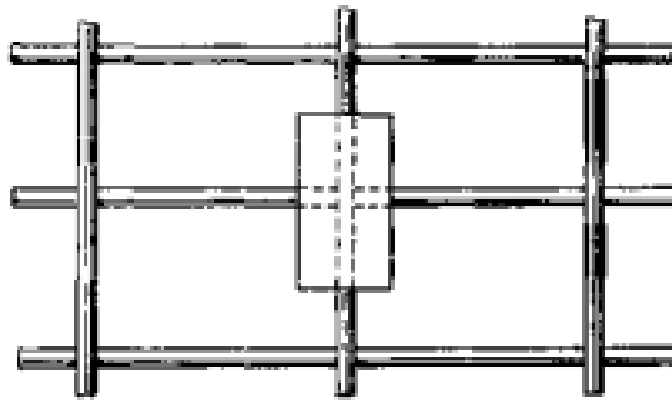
Схема розташування перетворювача при контролі конструкцій, що містять подовжню і поперечну арматури.
